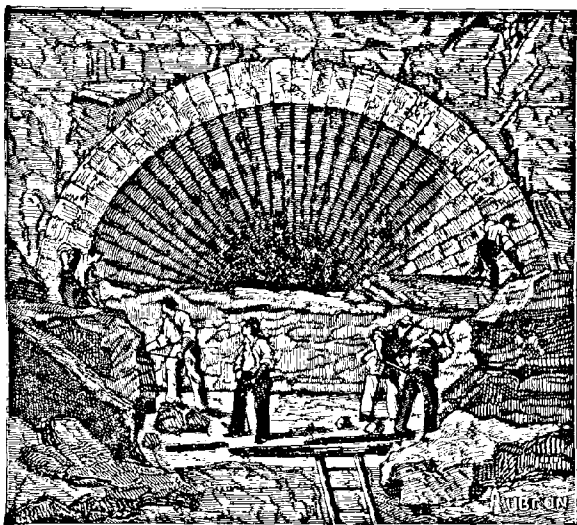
Construction de la voûte en maçonnerie d'un tunnel.
